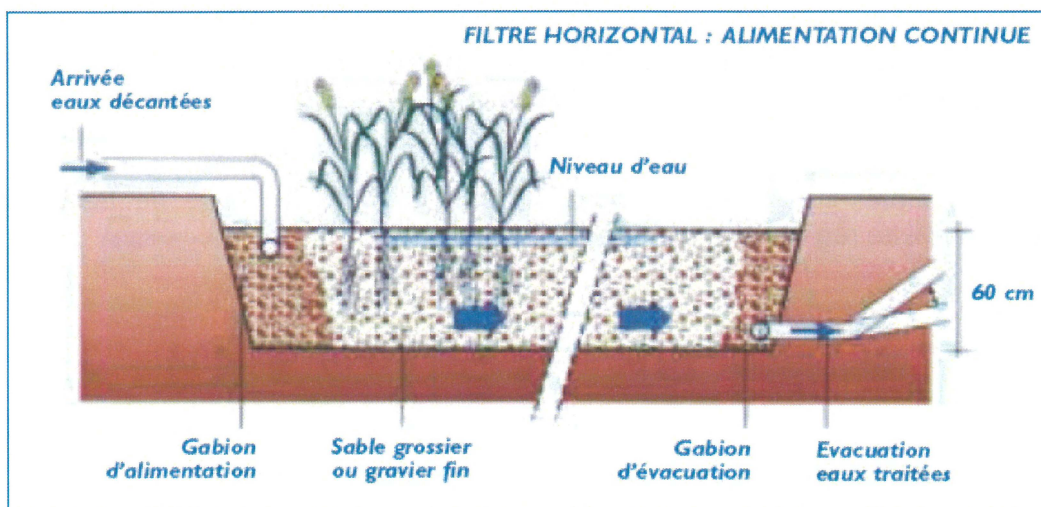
Coupe transversale d'un filtre planté de roseaux à écoulement horizontal
